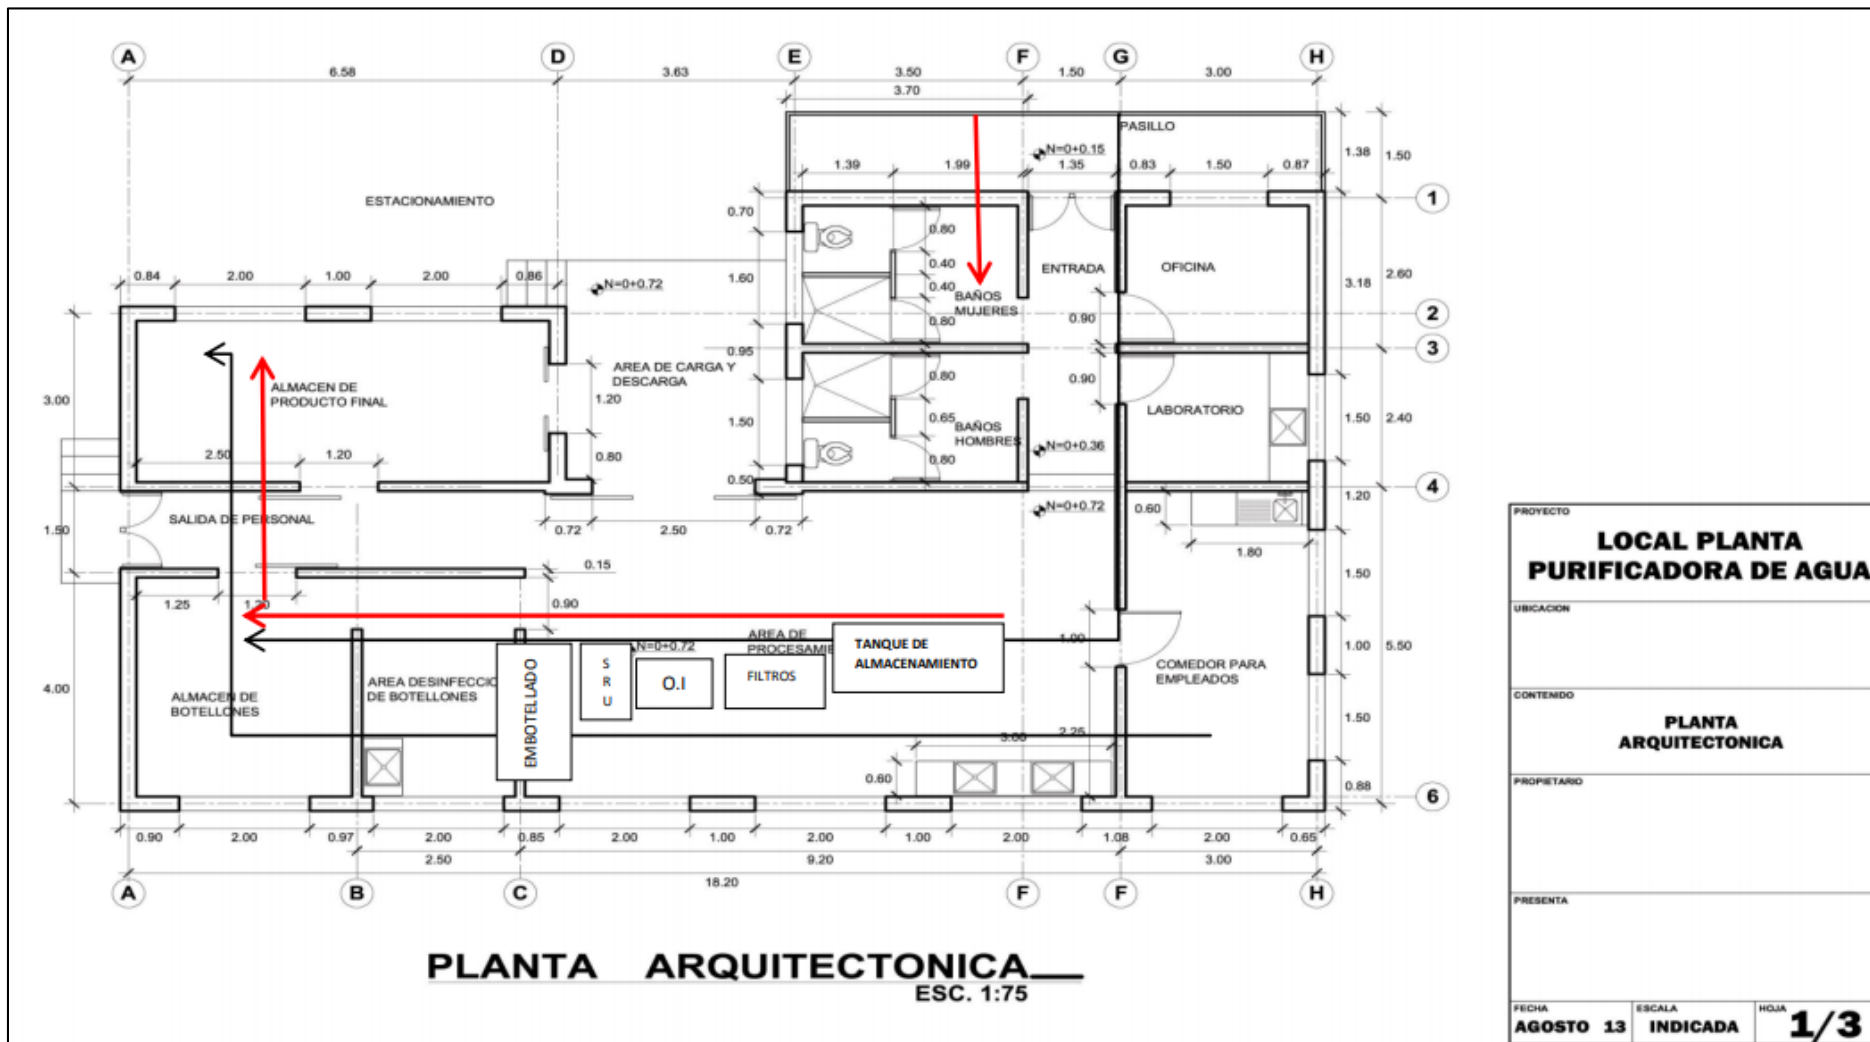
Diseño Planta Arquitectónica* (Rodríguez, 2013)
